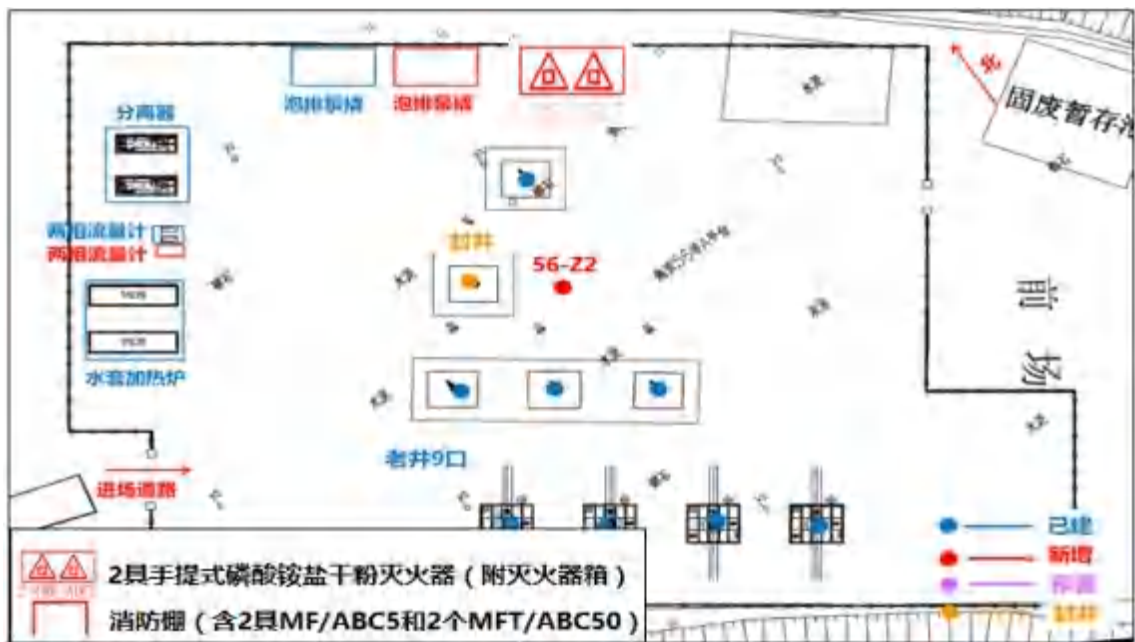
焦页 56 号 A 平台（扩建）灭火器配置平面图
